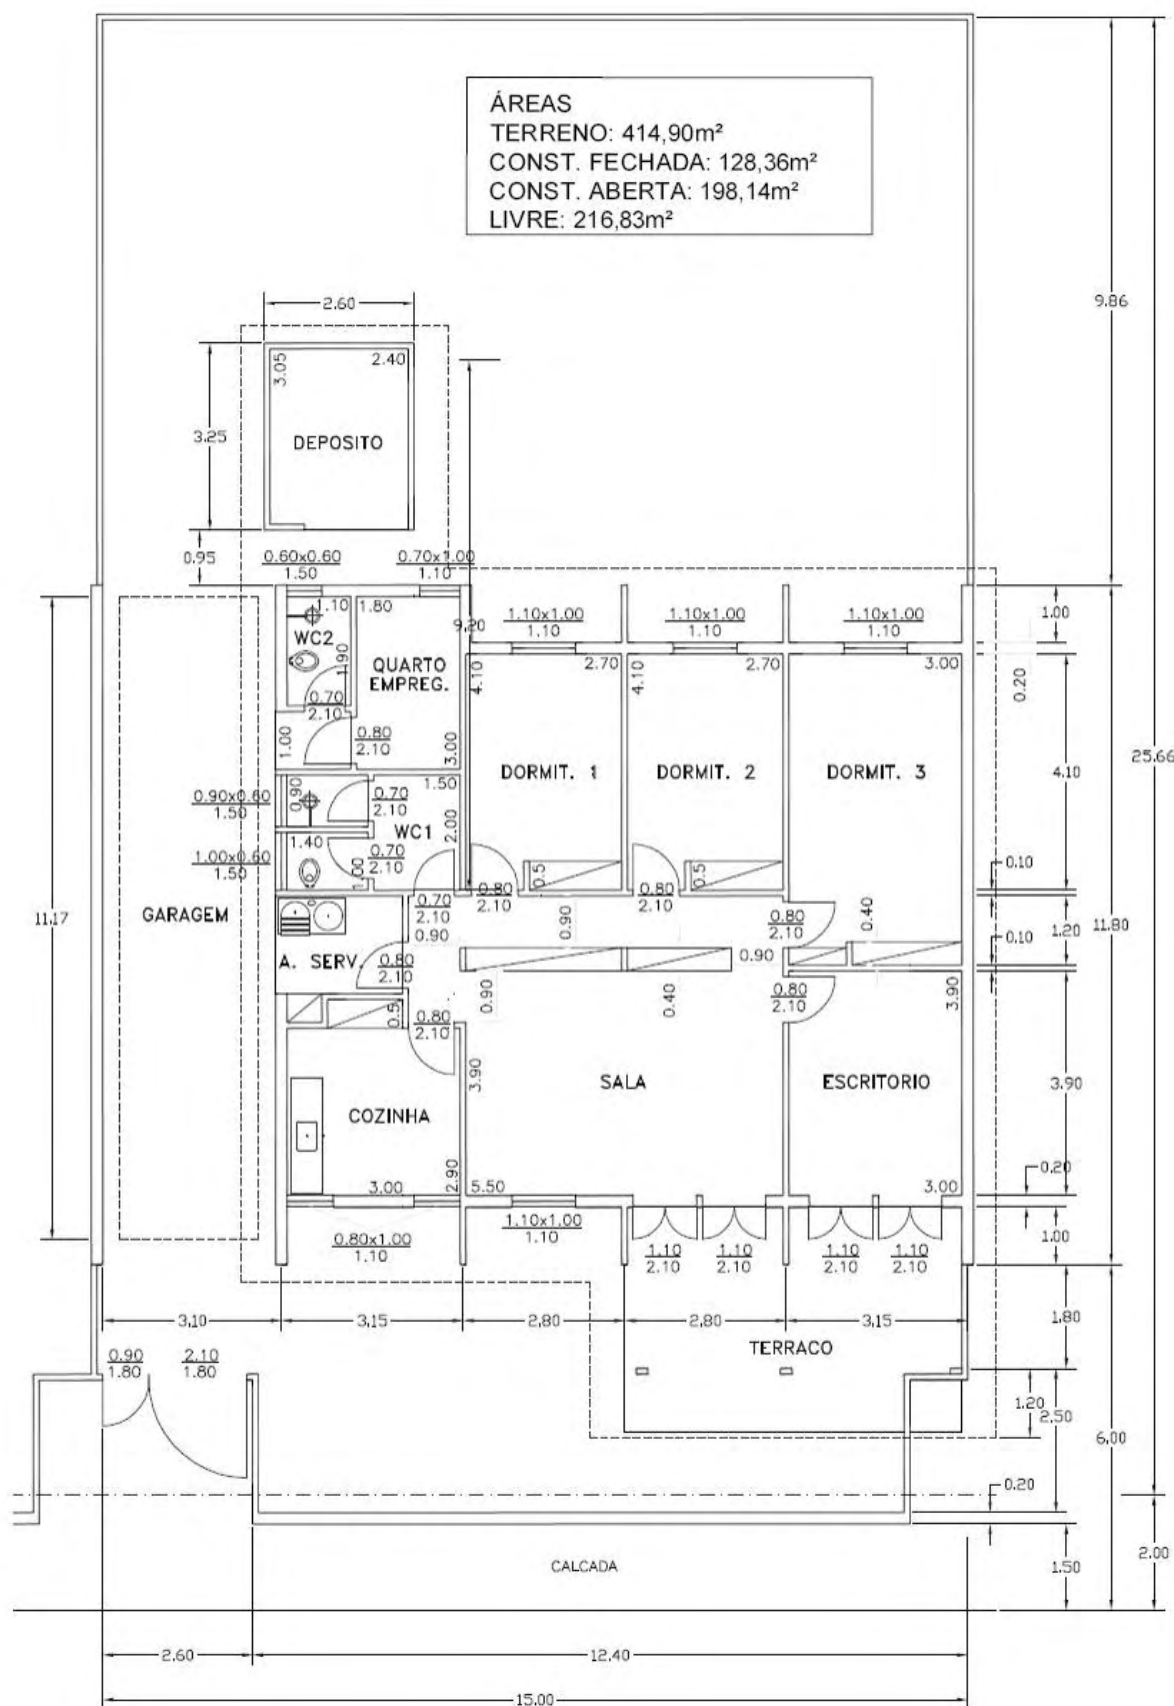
Figura G – Planta da casa tipo 5 (MANGE; KATO, 1963)
